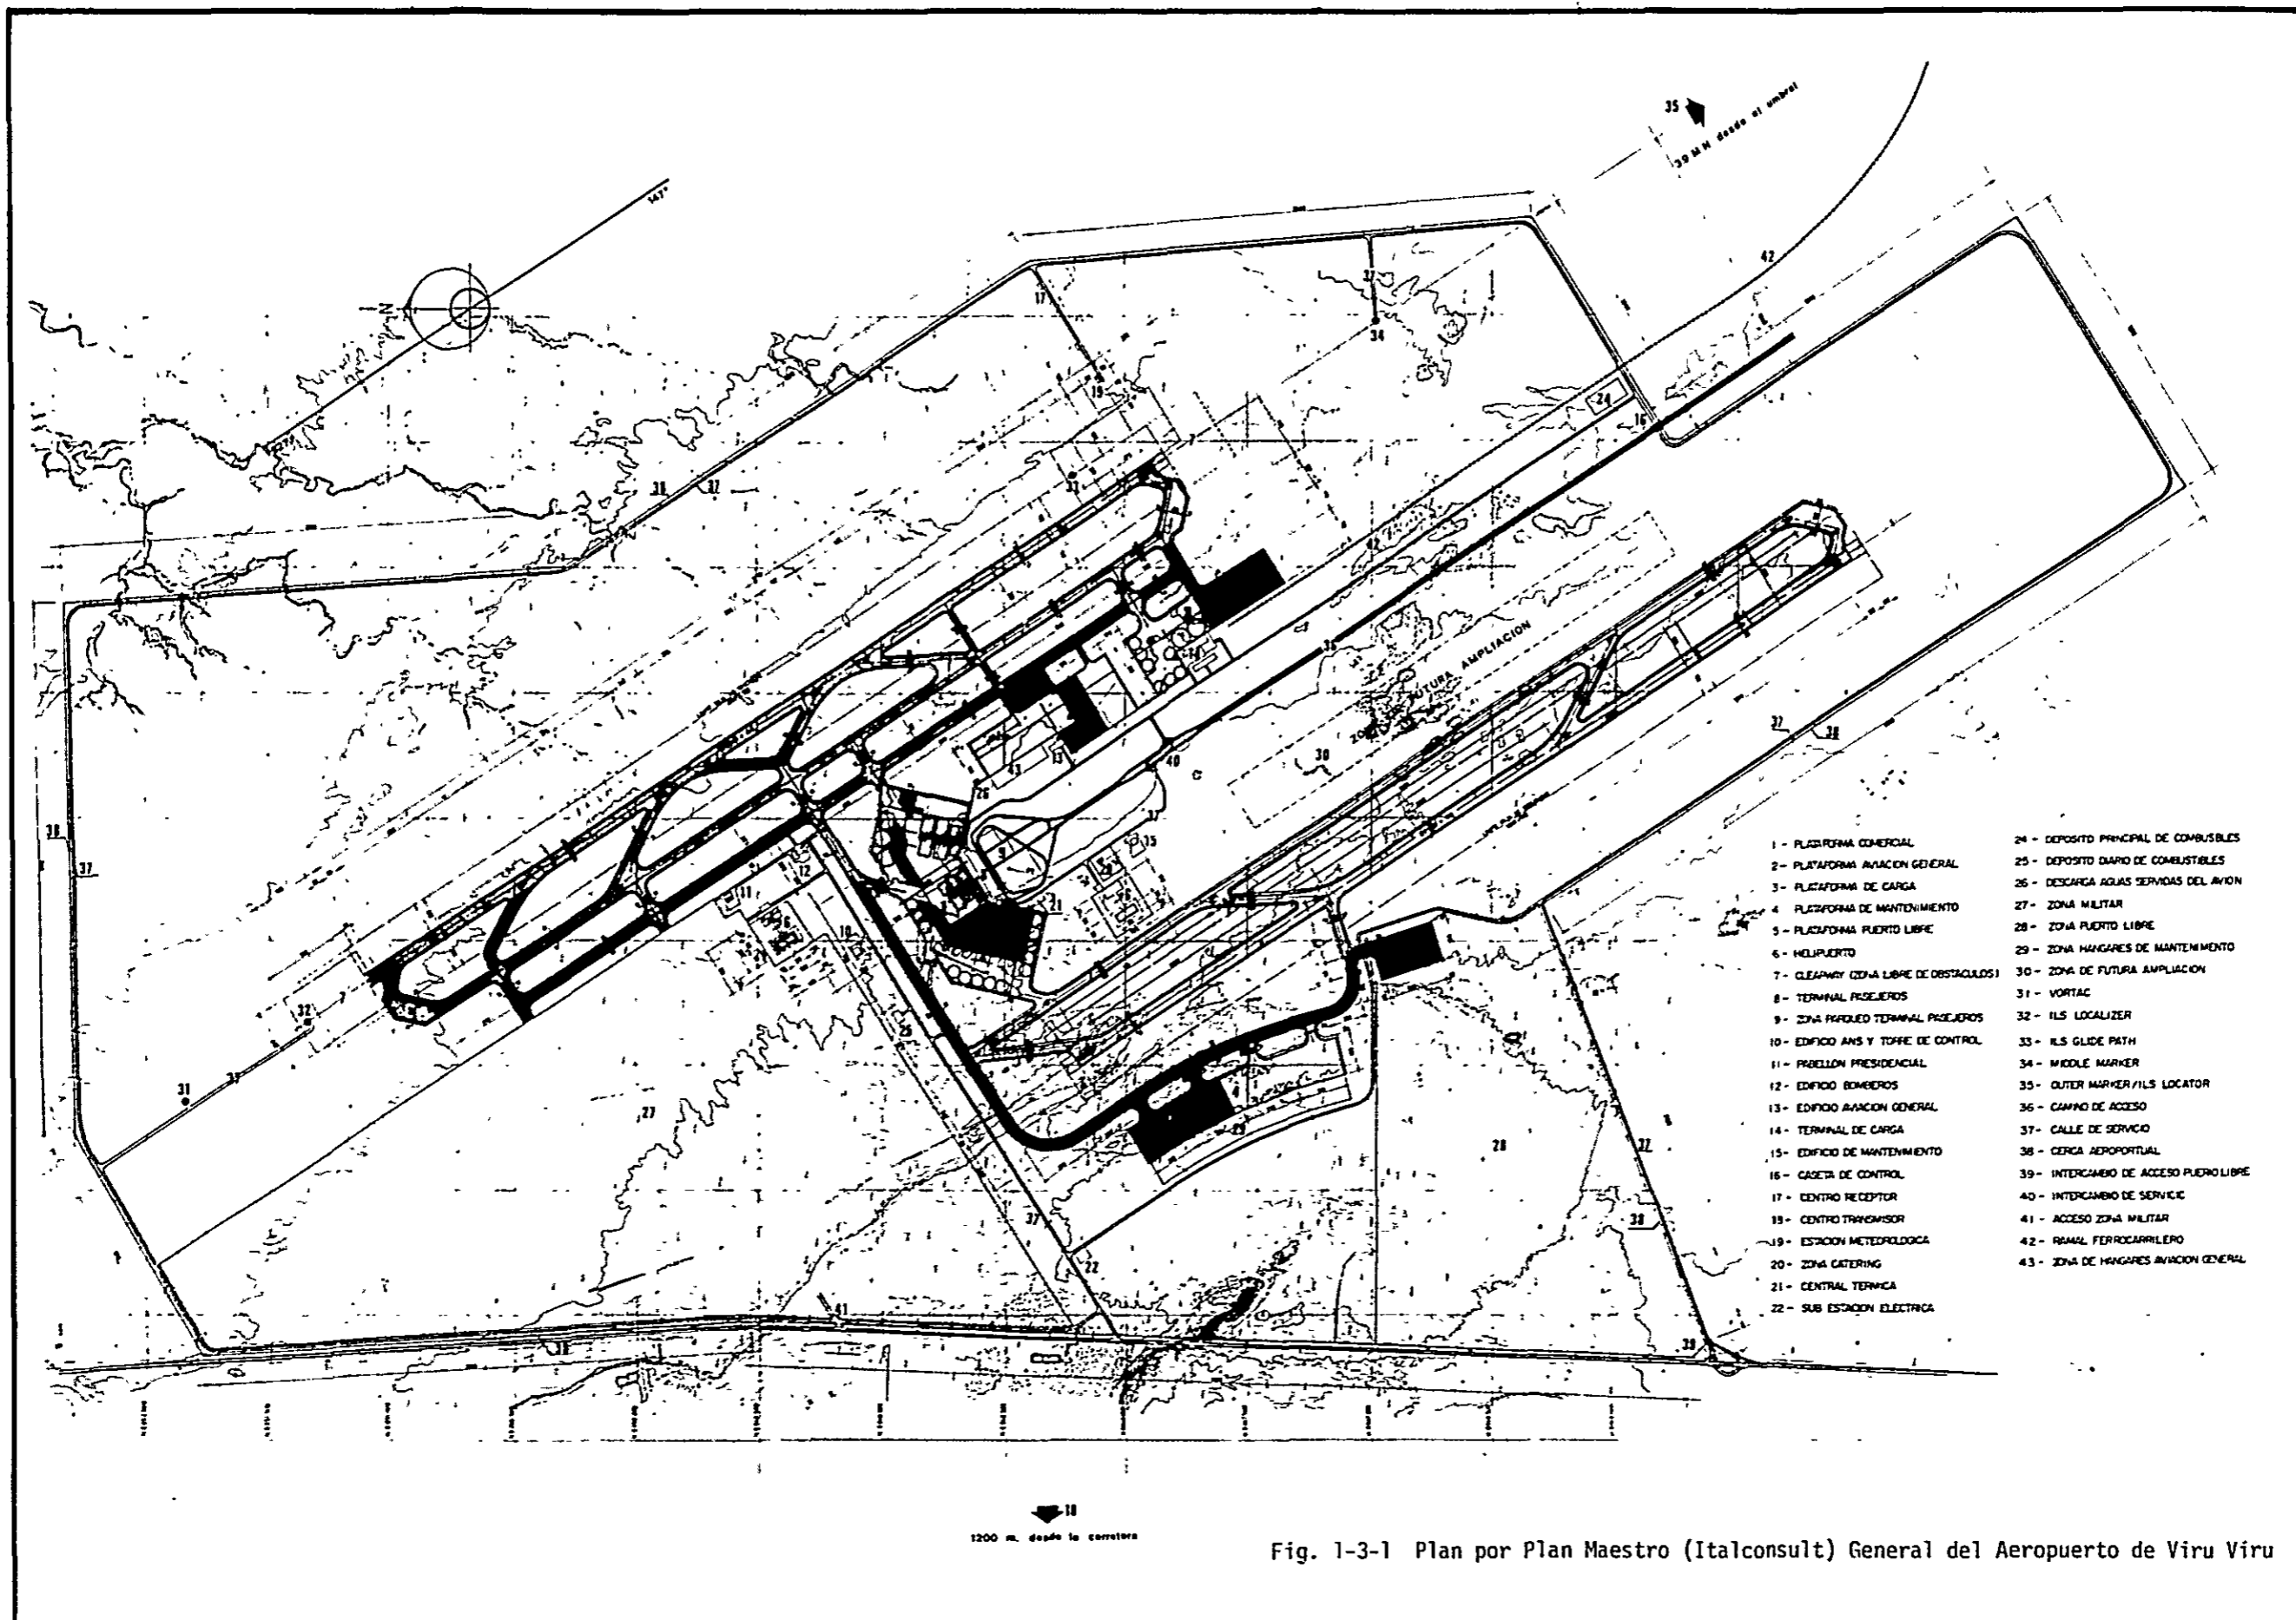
Plan por Plan Maestro (Italconsult) General del Aeropuerto de Viru Viru
